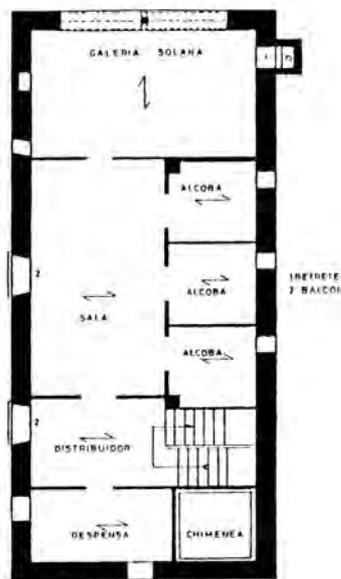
Plantas de casa Pérez (C18) (Sasé).
